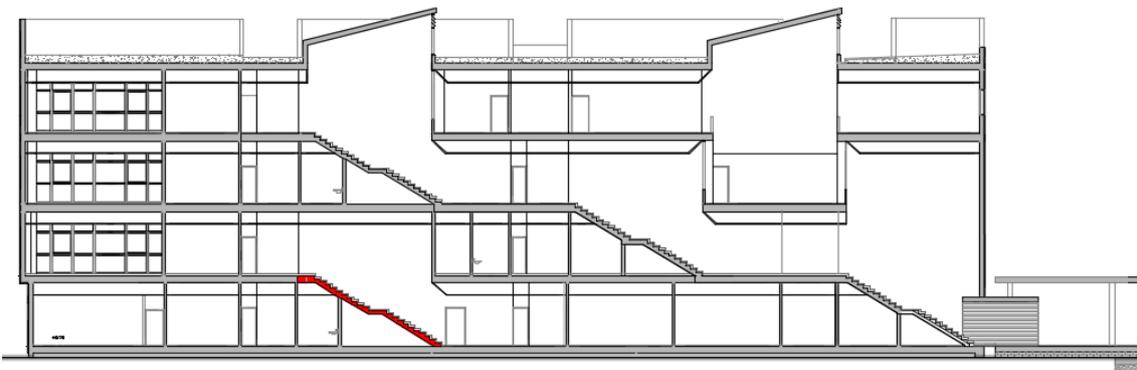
Situación escalera Planta Baja-Primera. Figura extraída del plano 32.
